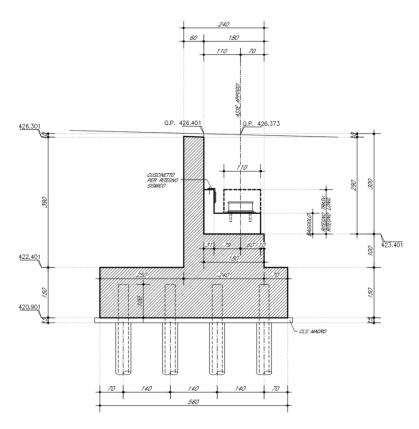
Sezione in asse tracciamento spalla A
